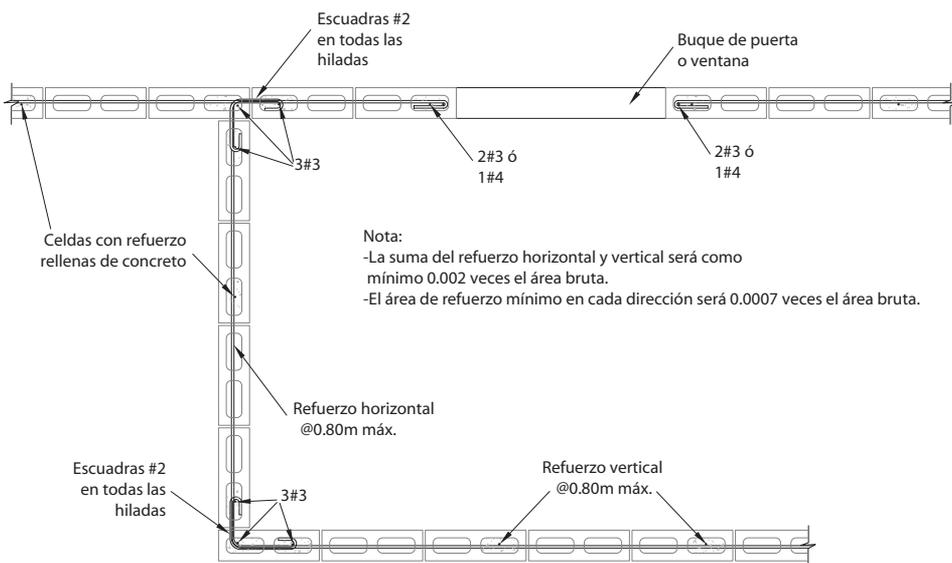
Sección de pared de mampostería con refuerzo integral.
